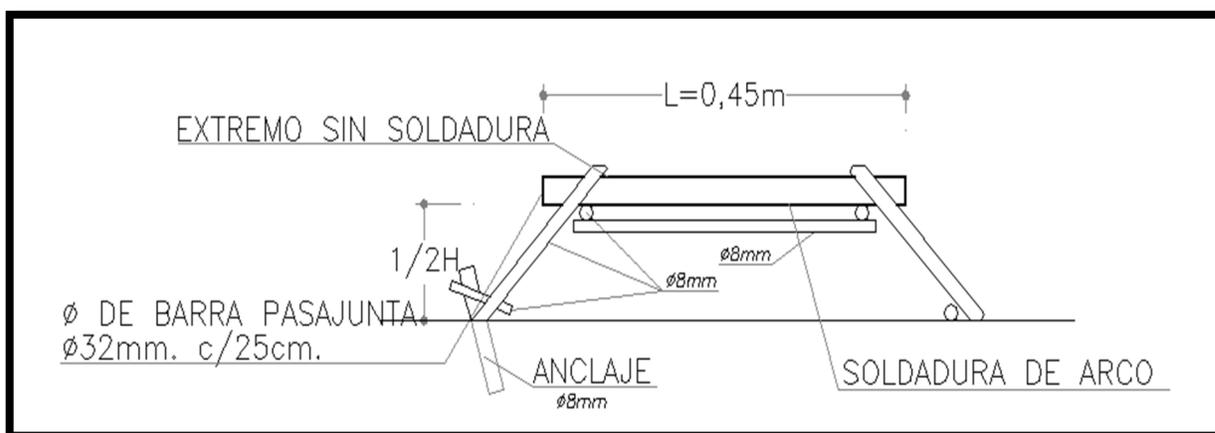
Vista en corte de la canasta pasajuntas en juntas transversales de construcción
